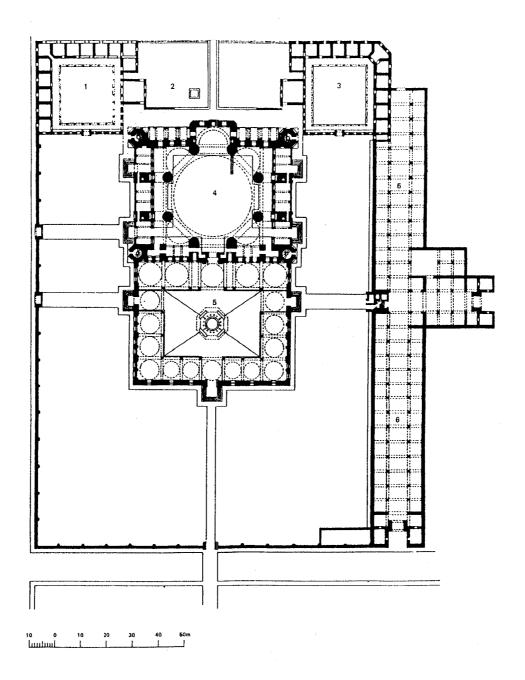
مسقط أفقي لمسجد لاري چلبي في أدرنة (عن : Tüksel).
